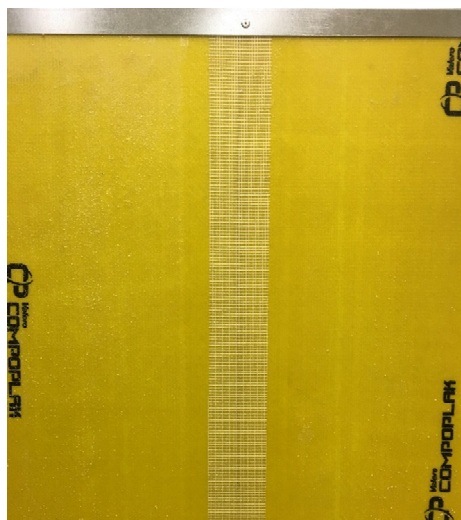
Unión de los paneles mediante soldadura química (malla de fibra de vidrio + resina de poliéster).
